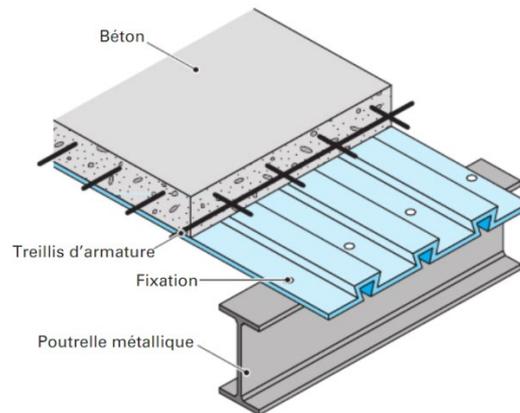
Plancher mixte avec tôle nervurée ¹²⁷
